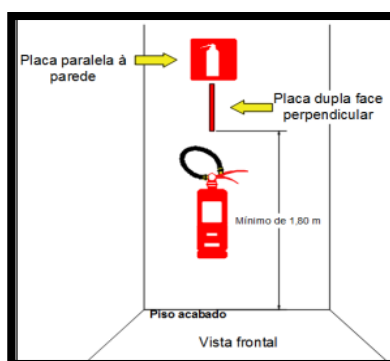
Placa com indicação extintor deve ser colocada a 1,80 do piso do chão.
